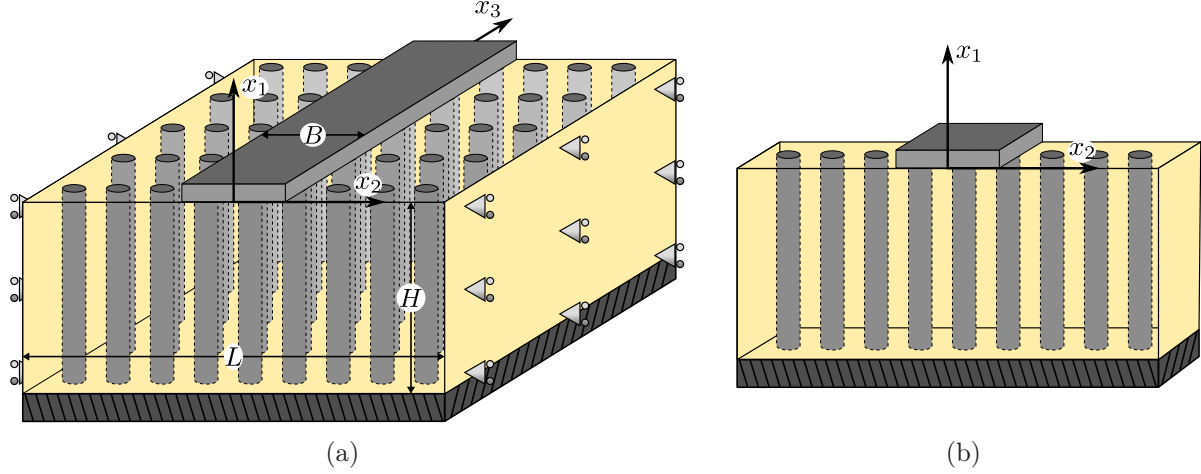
Semelle filante reposant sur un massif de fondation en sol renforcé par colonnes.
